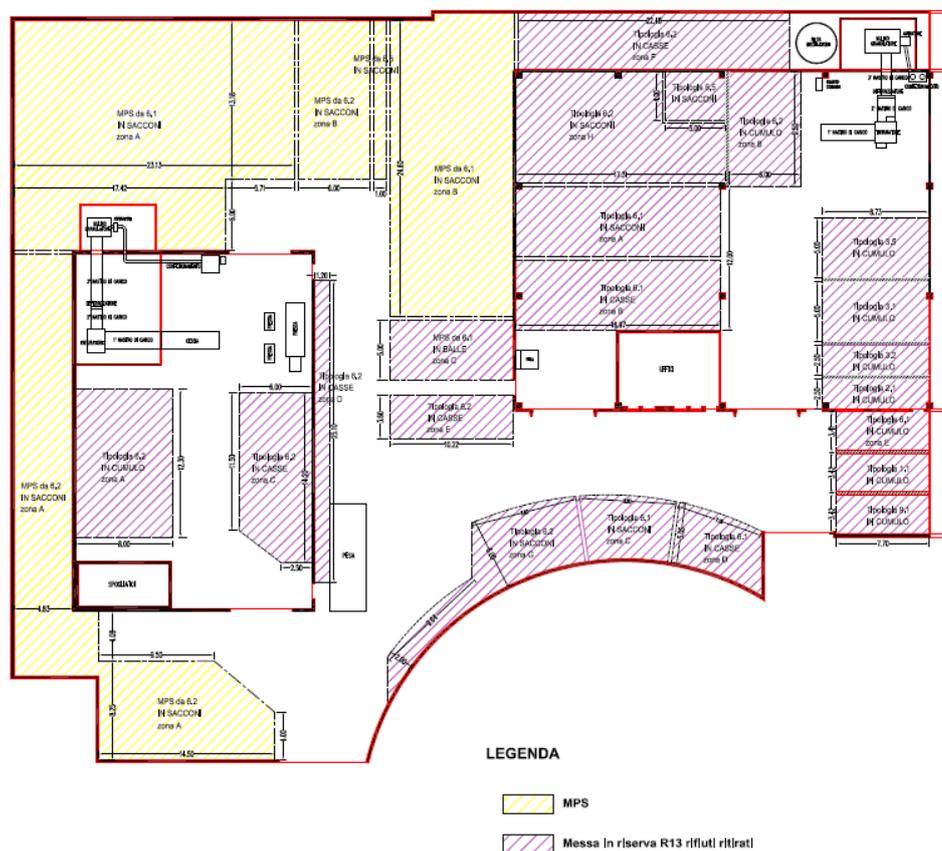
Planimetria dell'impianto produttivo – stato attuale
